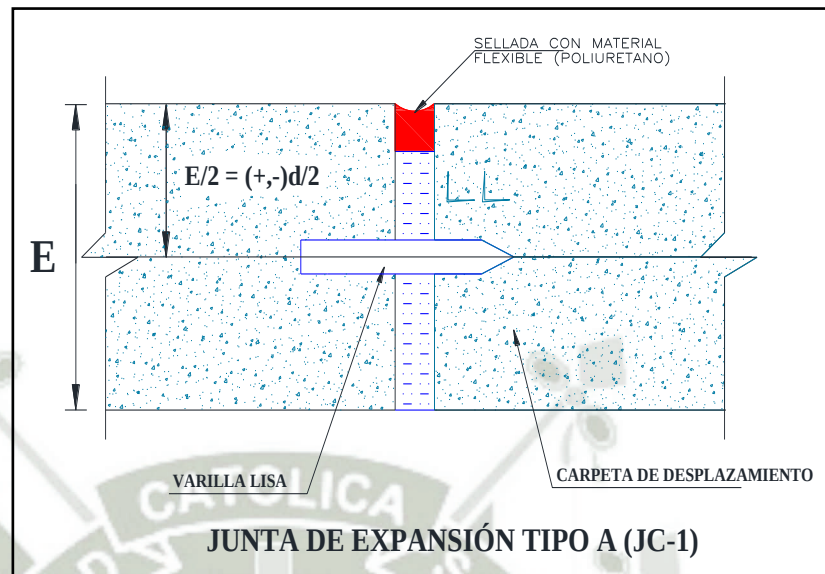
Junta de expansión tipo A (JC-1)
